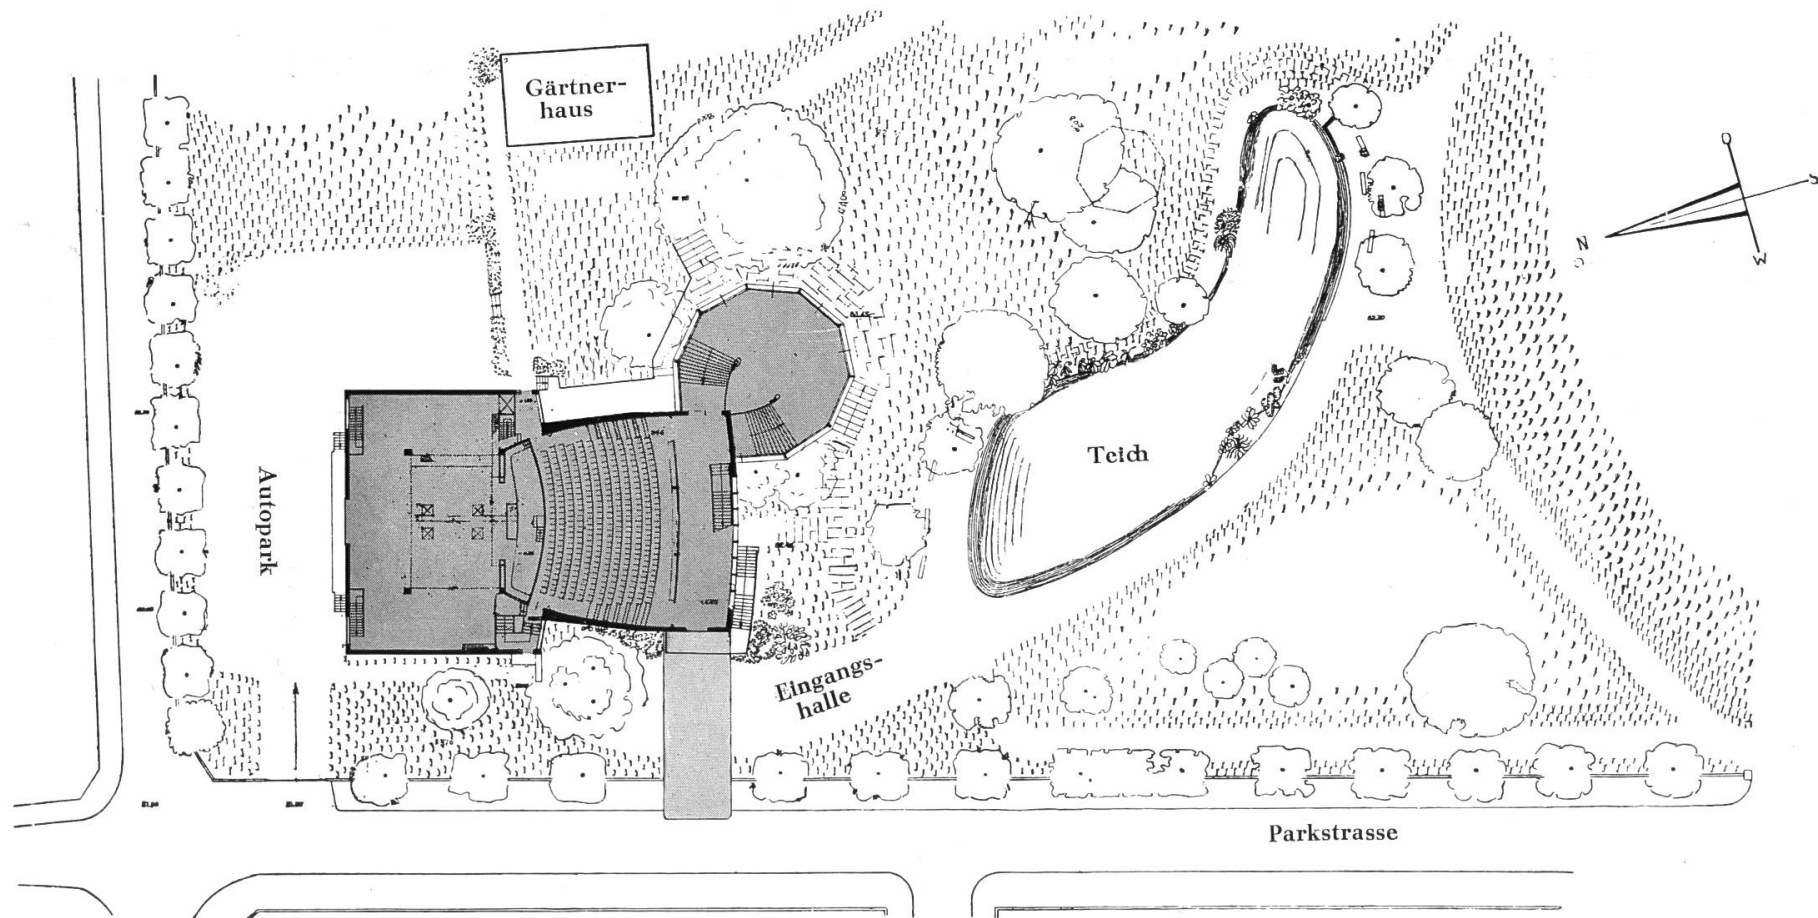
Kurtheater Baden. Situation im Kurpark und Grundriss des Theaters.
